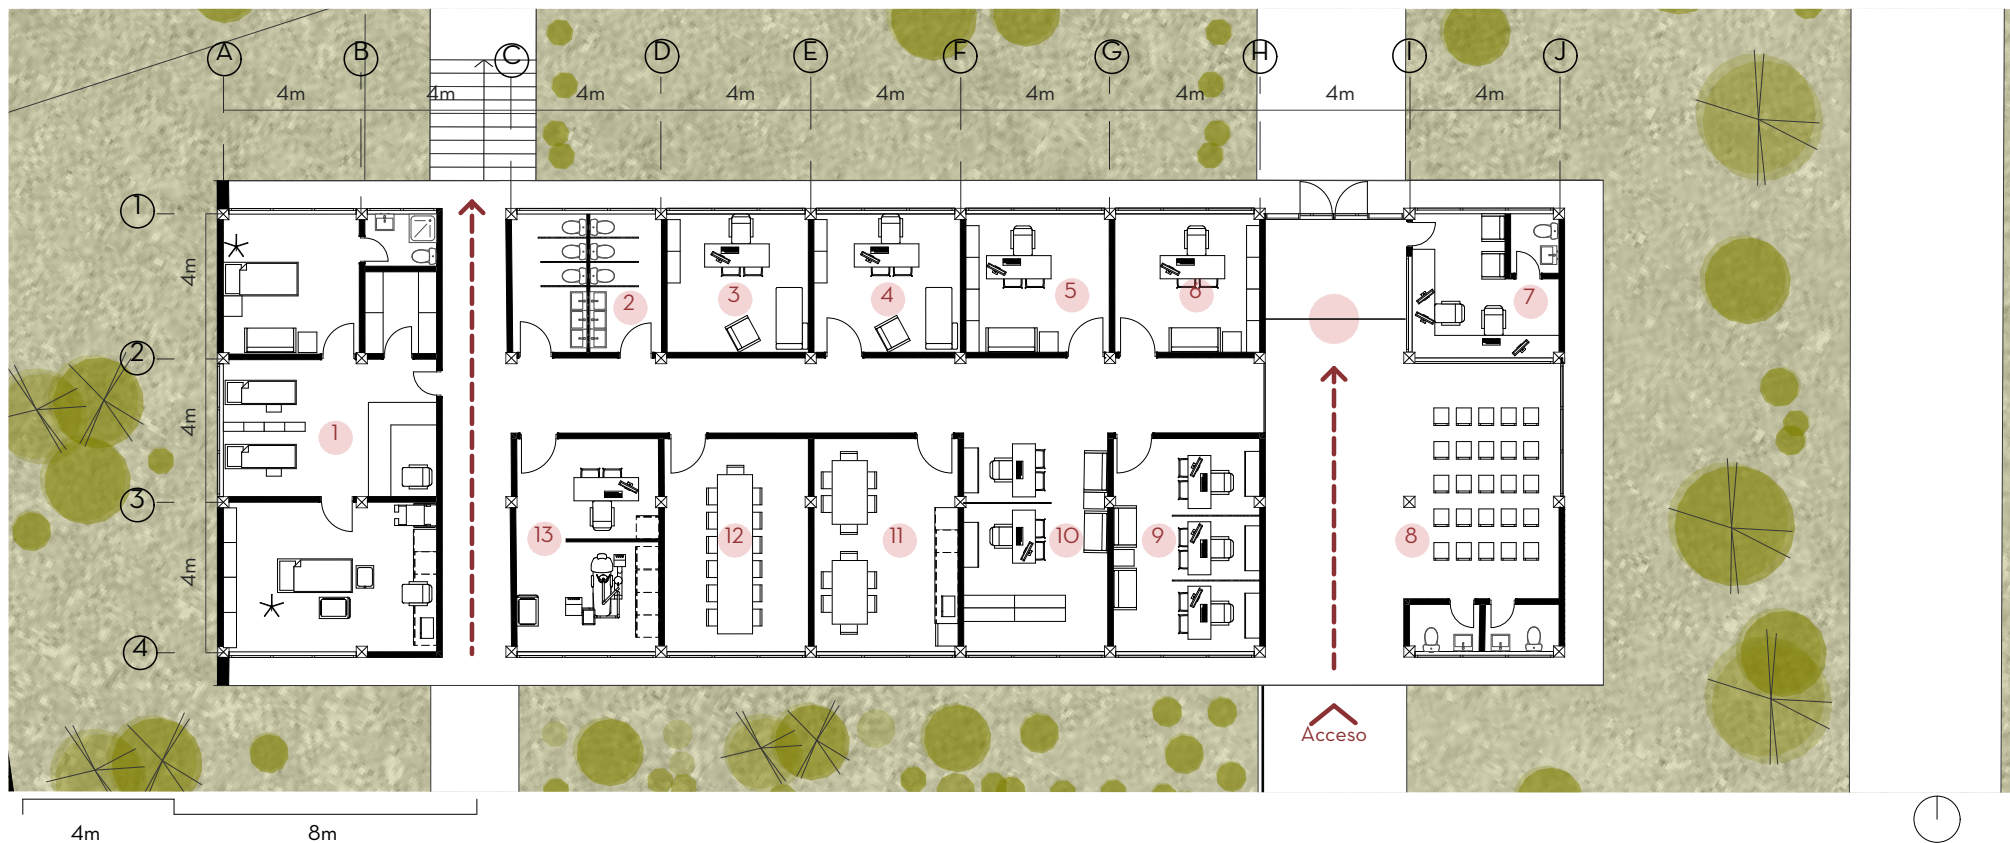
Planta del bloque de administración. Fuente: Autoría propia.
